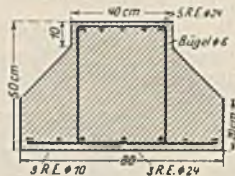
Durchbildung der Grundmauer eines im Bergwerksgebiet stehenden Wohnhauses.
